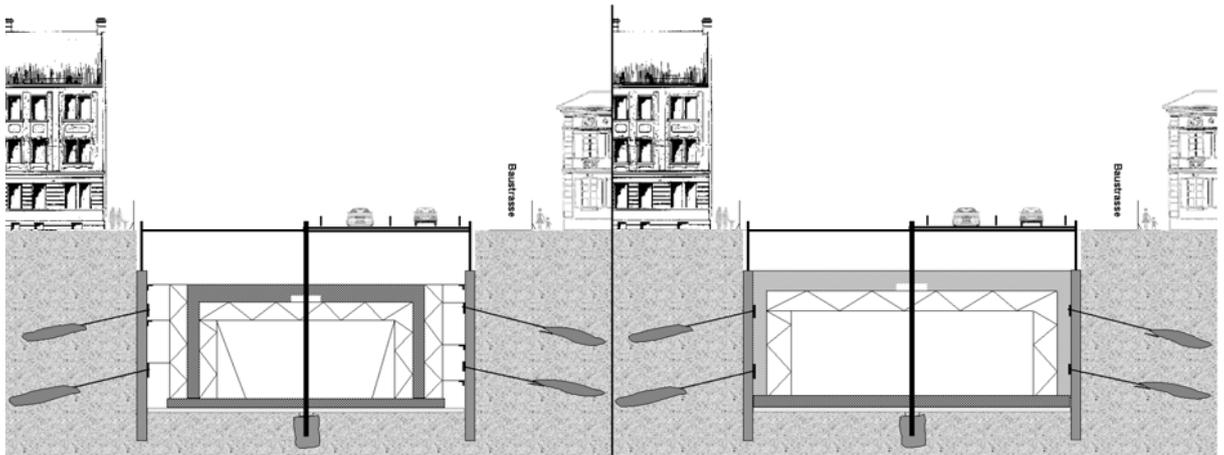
Ausführungsvarianten des Tunnelquerschnitts
